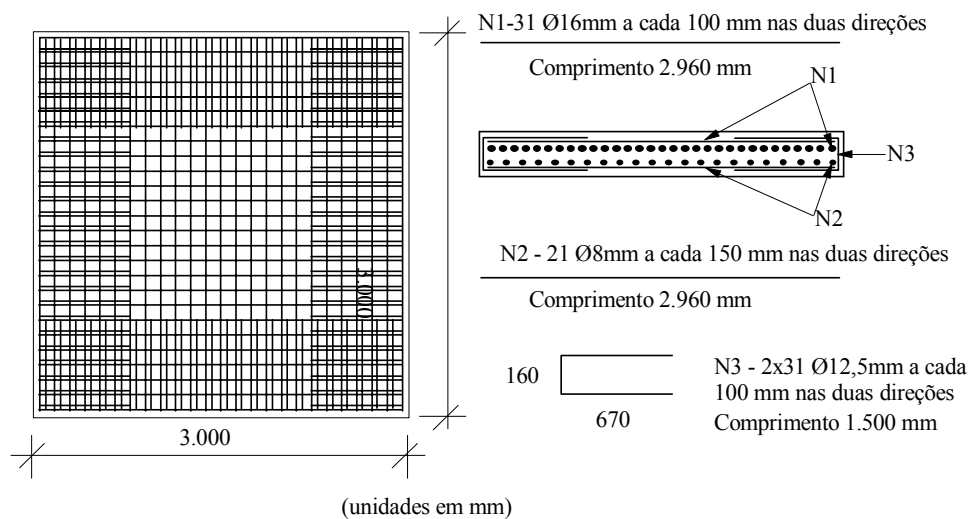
Detalhamento da armadura de flexão das lajes com pilares retangulares
